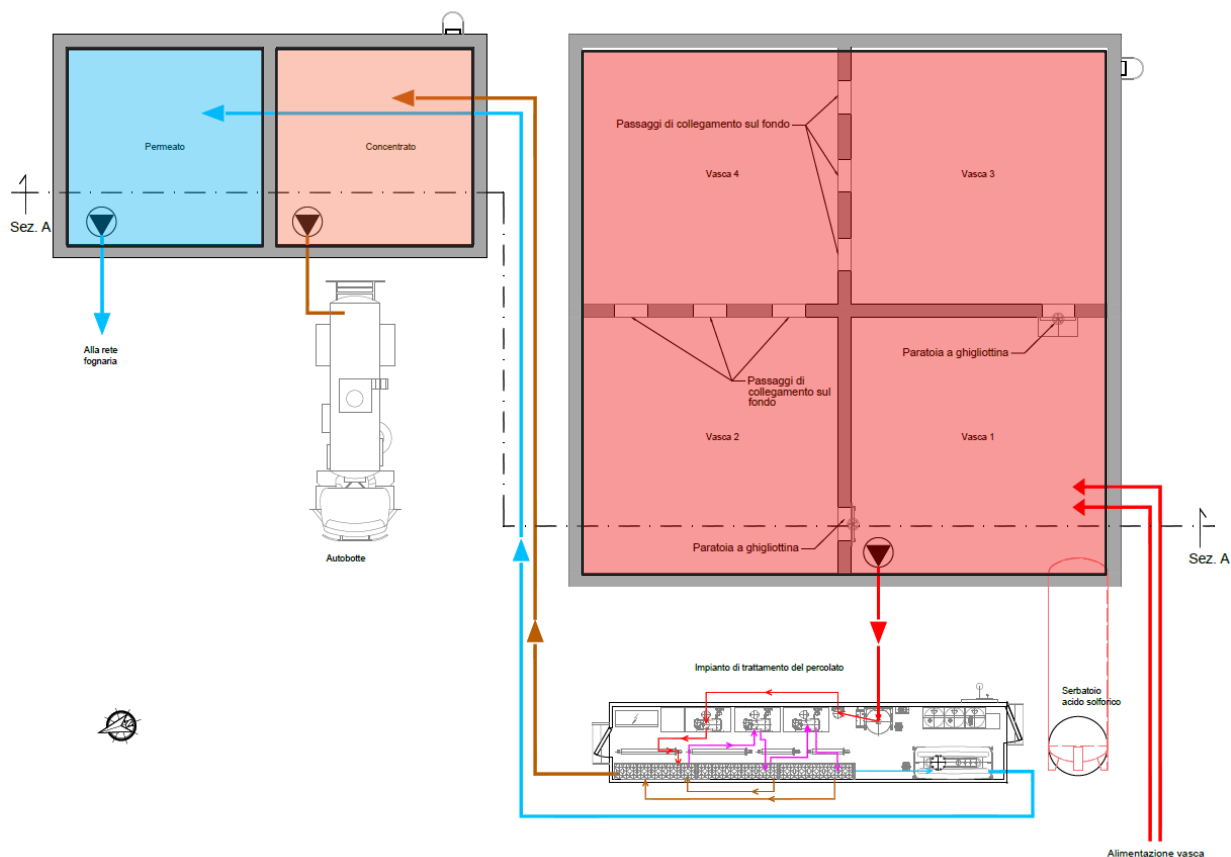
Planimetria e schema di flusso impianto di trattamento del percolato
